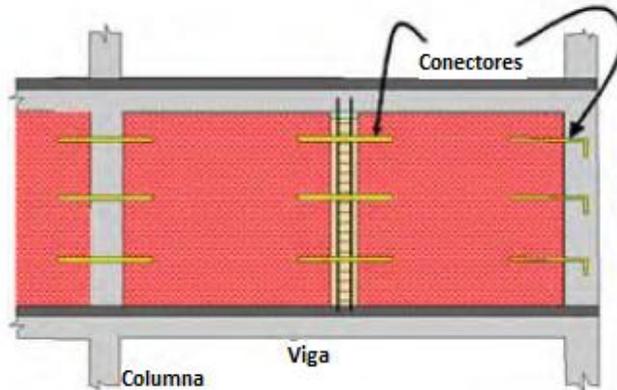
Detallado de los anclajes entre el muro de relleno y el marco cuando se necesita integrar el muro de mampostería con el marco del edificio (fuente: Murty et al. 2006).
